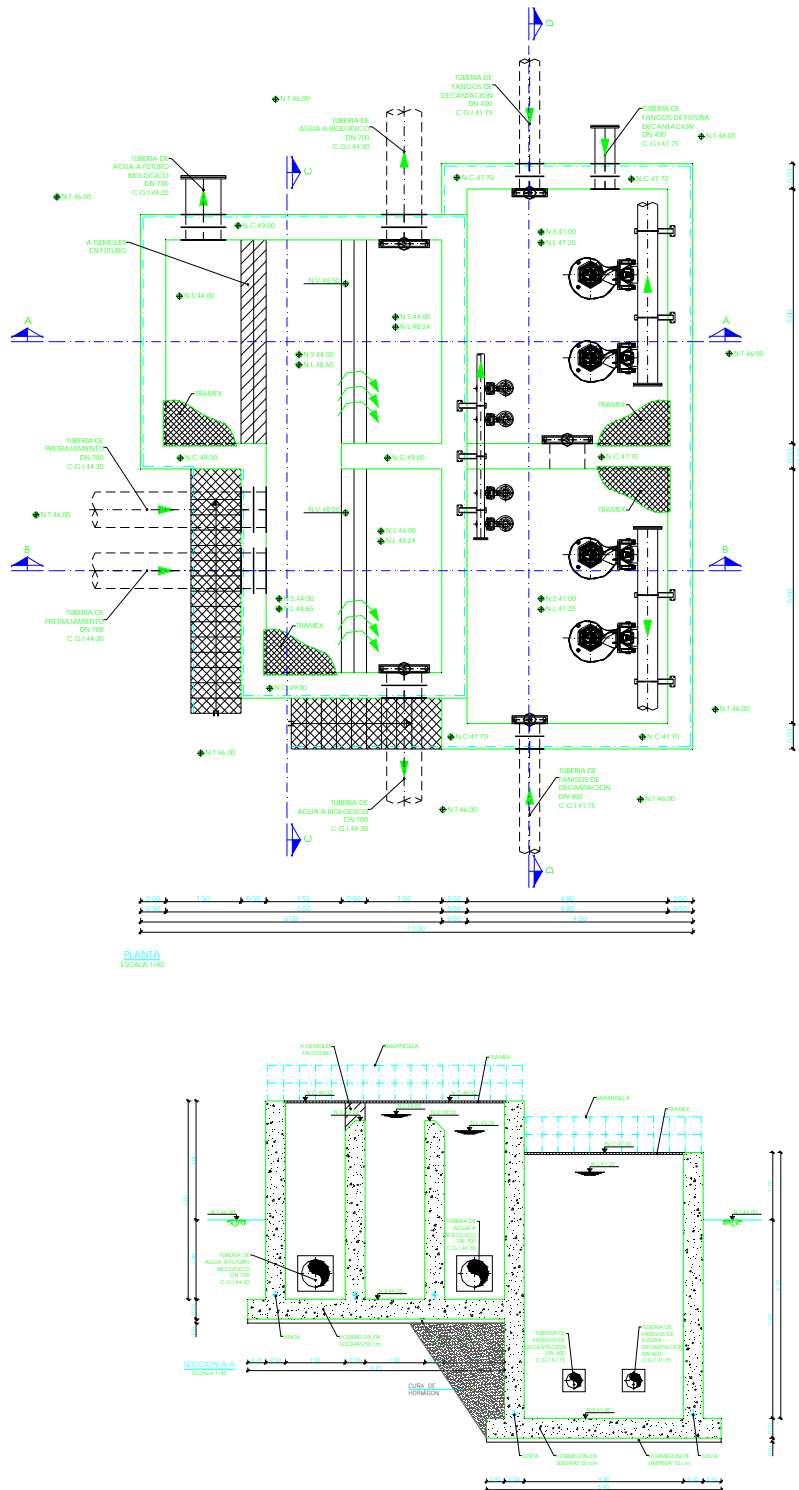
Planta y sección transversal arqueta de reparto y recirculación de fangos.
